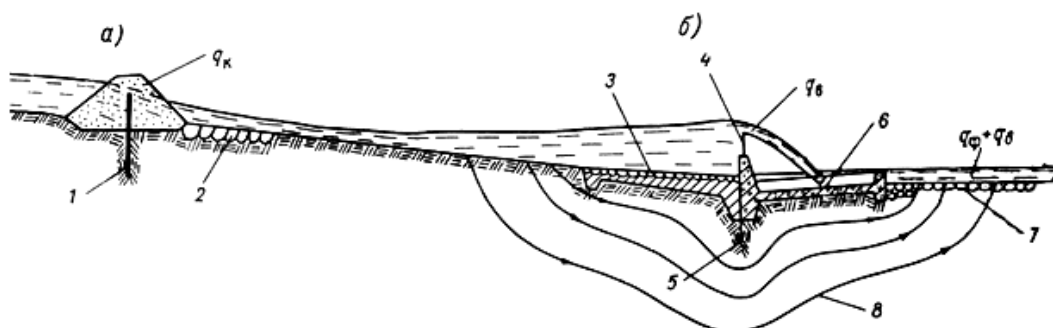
Схема к определению фильтрационных потерь в расходомере-водосливе
